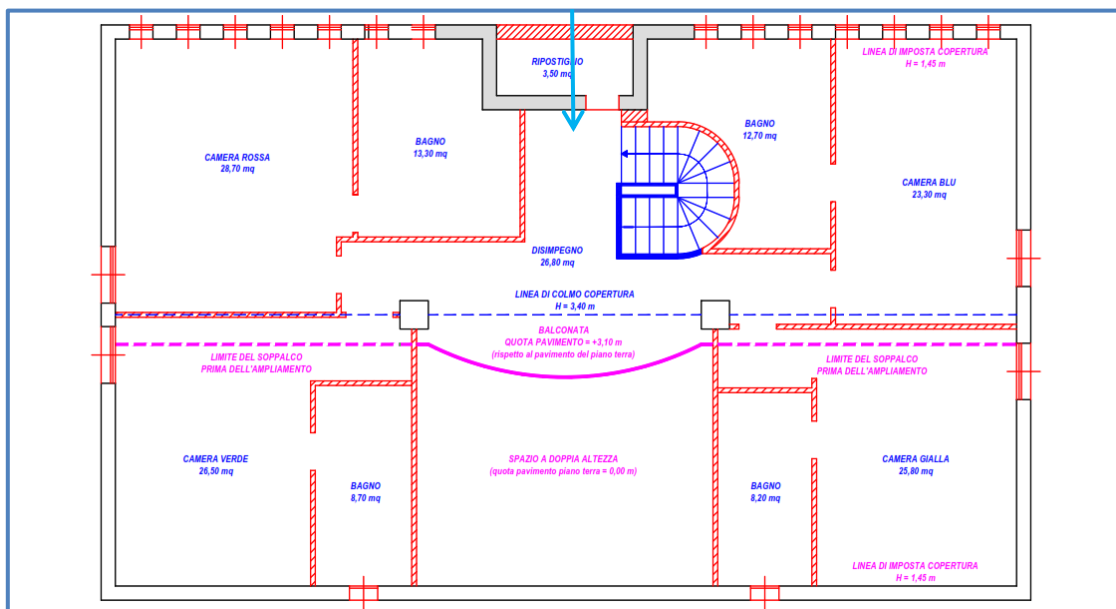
piano soppalcato - stato attuale dei luoghi rilevato dal CT del fallimento
